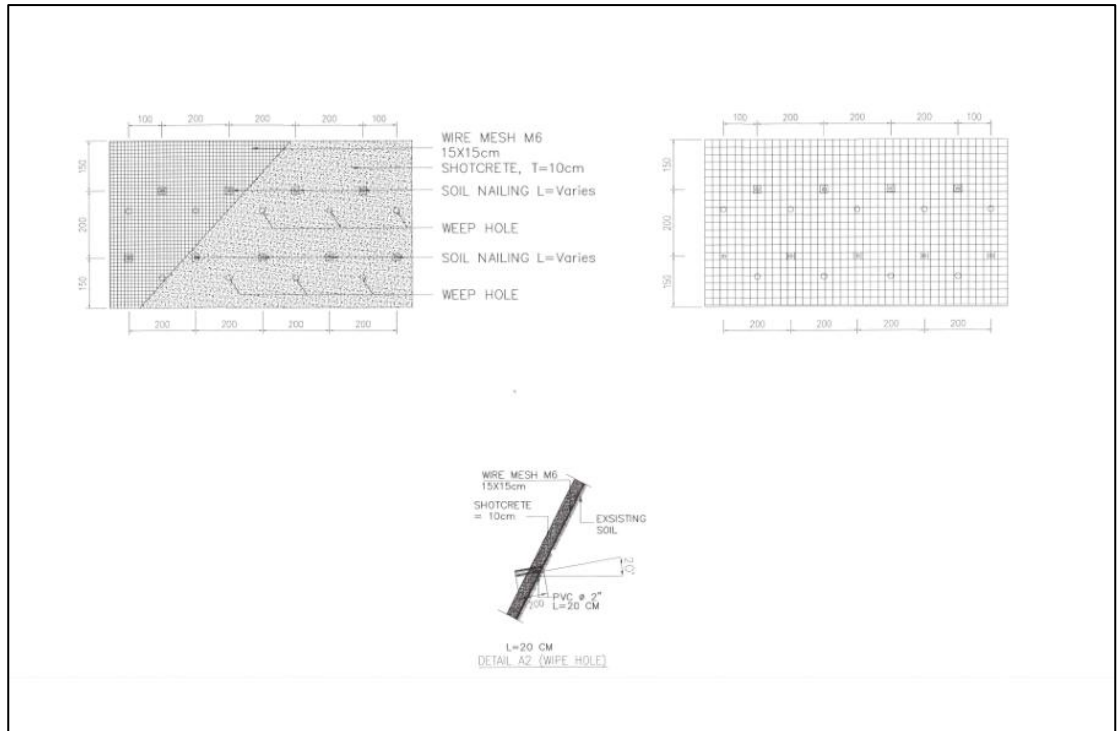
merupakan potongan melintang (*cross section*) lereng yang dilapisi lapisan *shotcrete* dan diperkuat dengan *soil nail*. Detail A5 merupakan bagian kepala (*head*) dari *soil nail* setelah pemasangan *grouting* dan sebelum penutupan dengan *shotcrete*. Dan detail A7 merupakan sistem drainase di balik lapisan *shotcrete* untuk mengurangi tekanan air pori (*pore water pressure*) di dalam lereng. Contoh dari detail A1, A5, A7, dan *typical shotcrete and soil nailing* ditunjukkan pada gambar 4.8 berikut:
